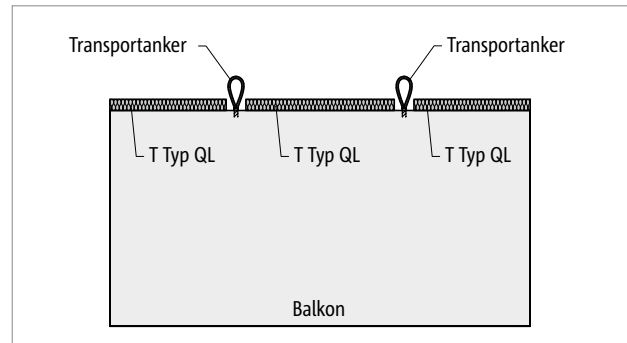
Schöck Isokorb® T Typ QL: Elementbalkon mit Transportanker; Dämmzwischenstück T Typ ZL muss beim Bestehen von Brandschutzanforderungen bauseitig eingelegt werden
